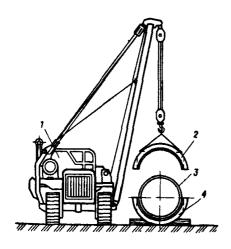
Установка грузов на трубопровод 1— трубоукладчик; 2— верхняя половина груза; 3— трубопровод; 4— нижняя половина груза
